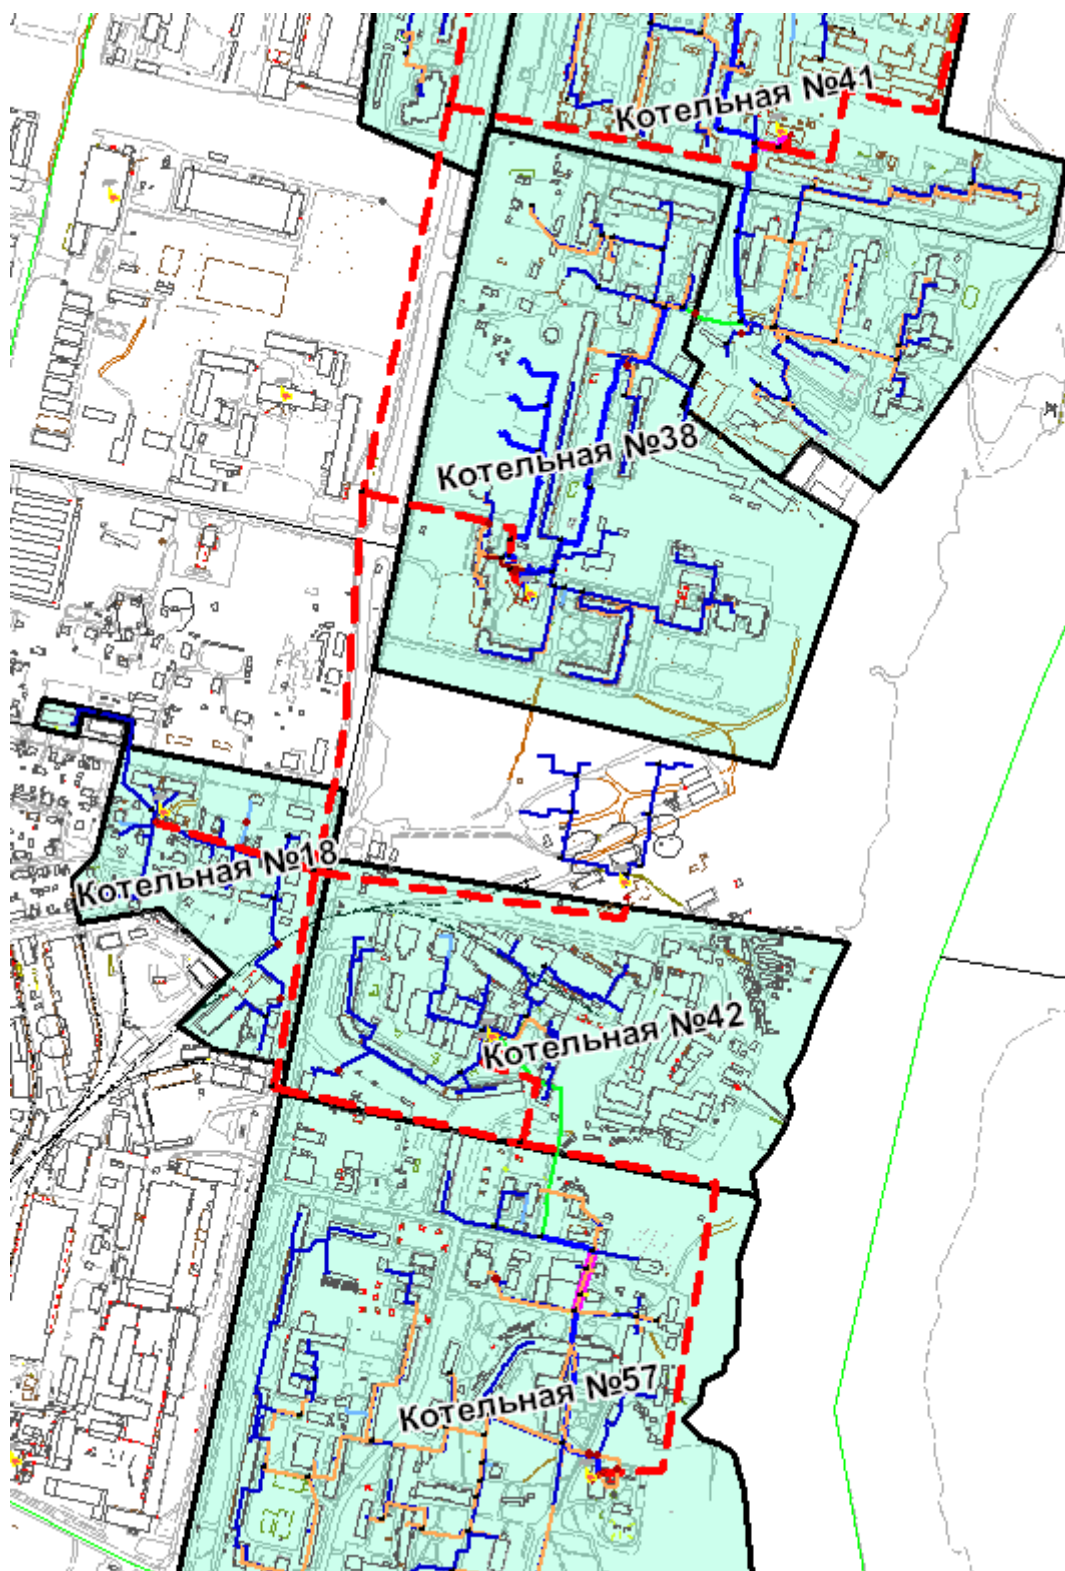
Схема прокладки тепловых сетей от ГТ ТЭС к котельным
